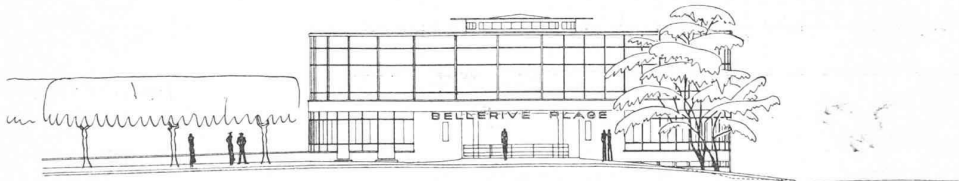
Façade de l'entrée. — Echelle 1 : 400.
